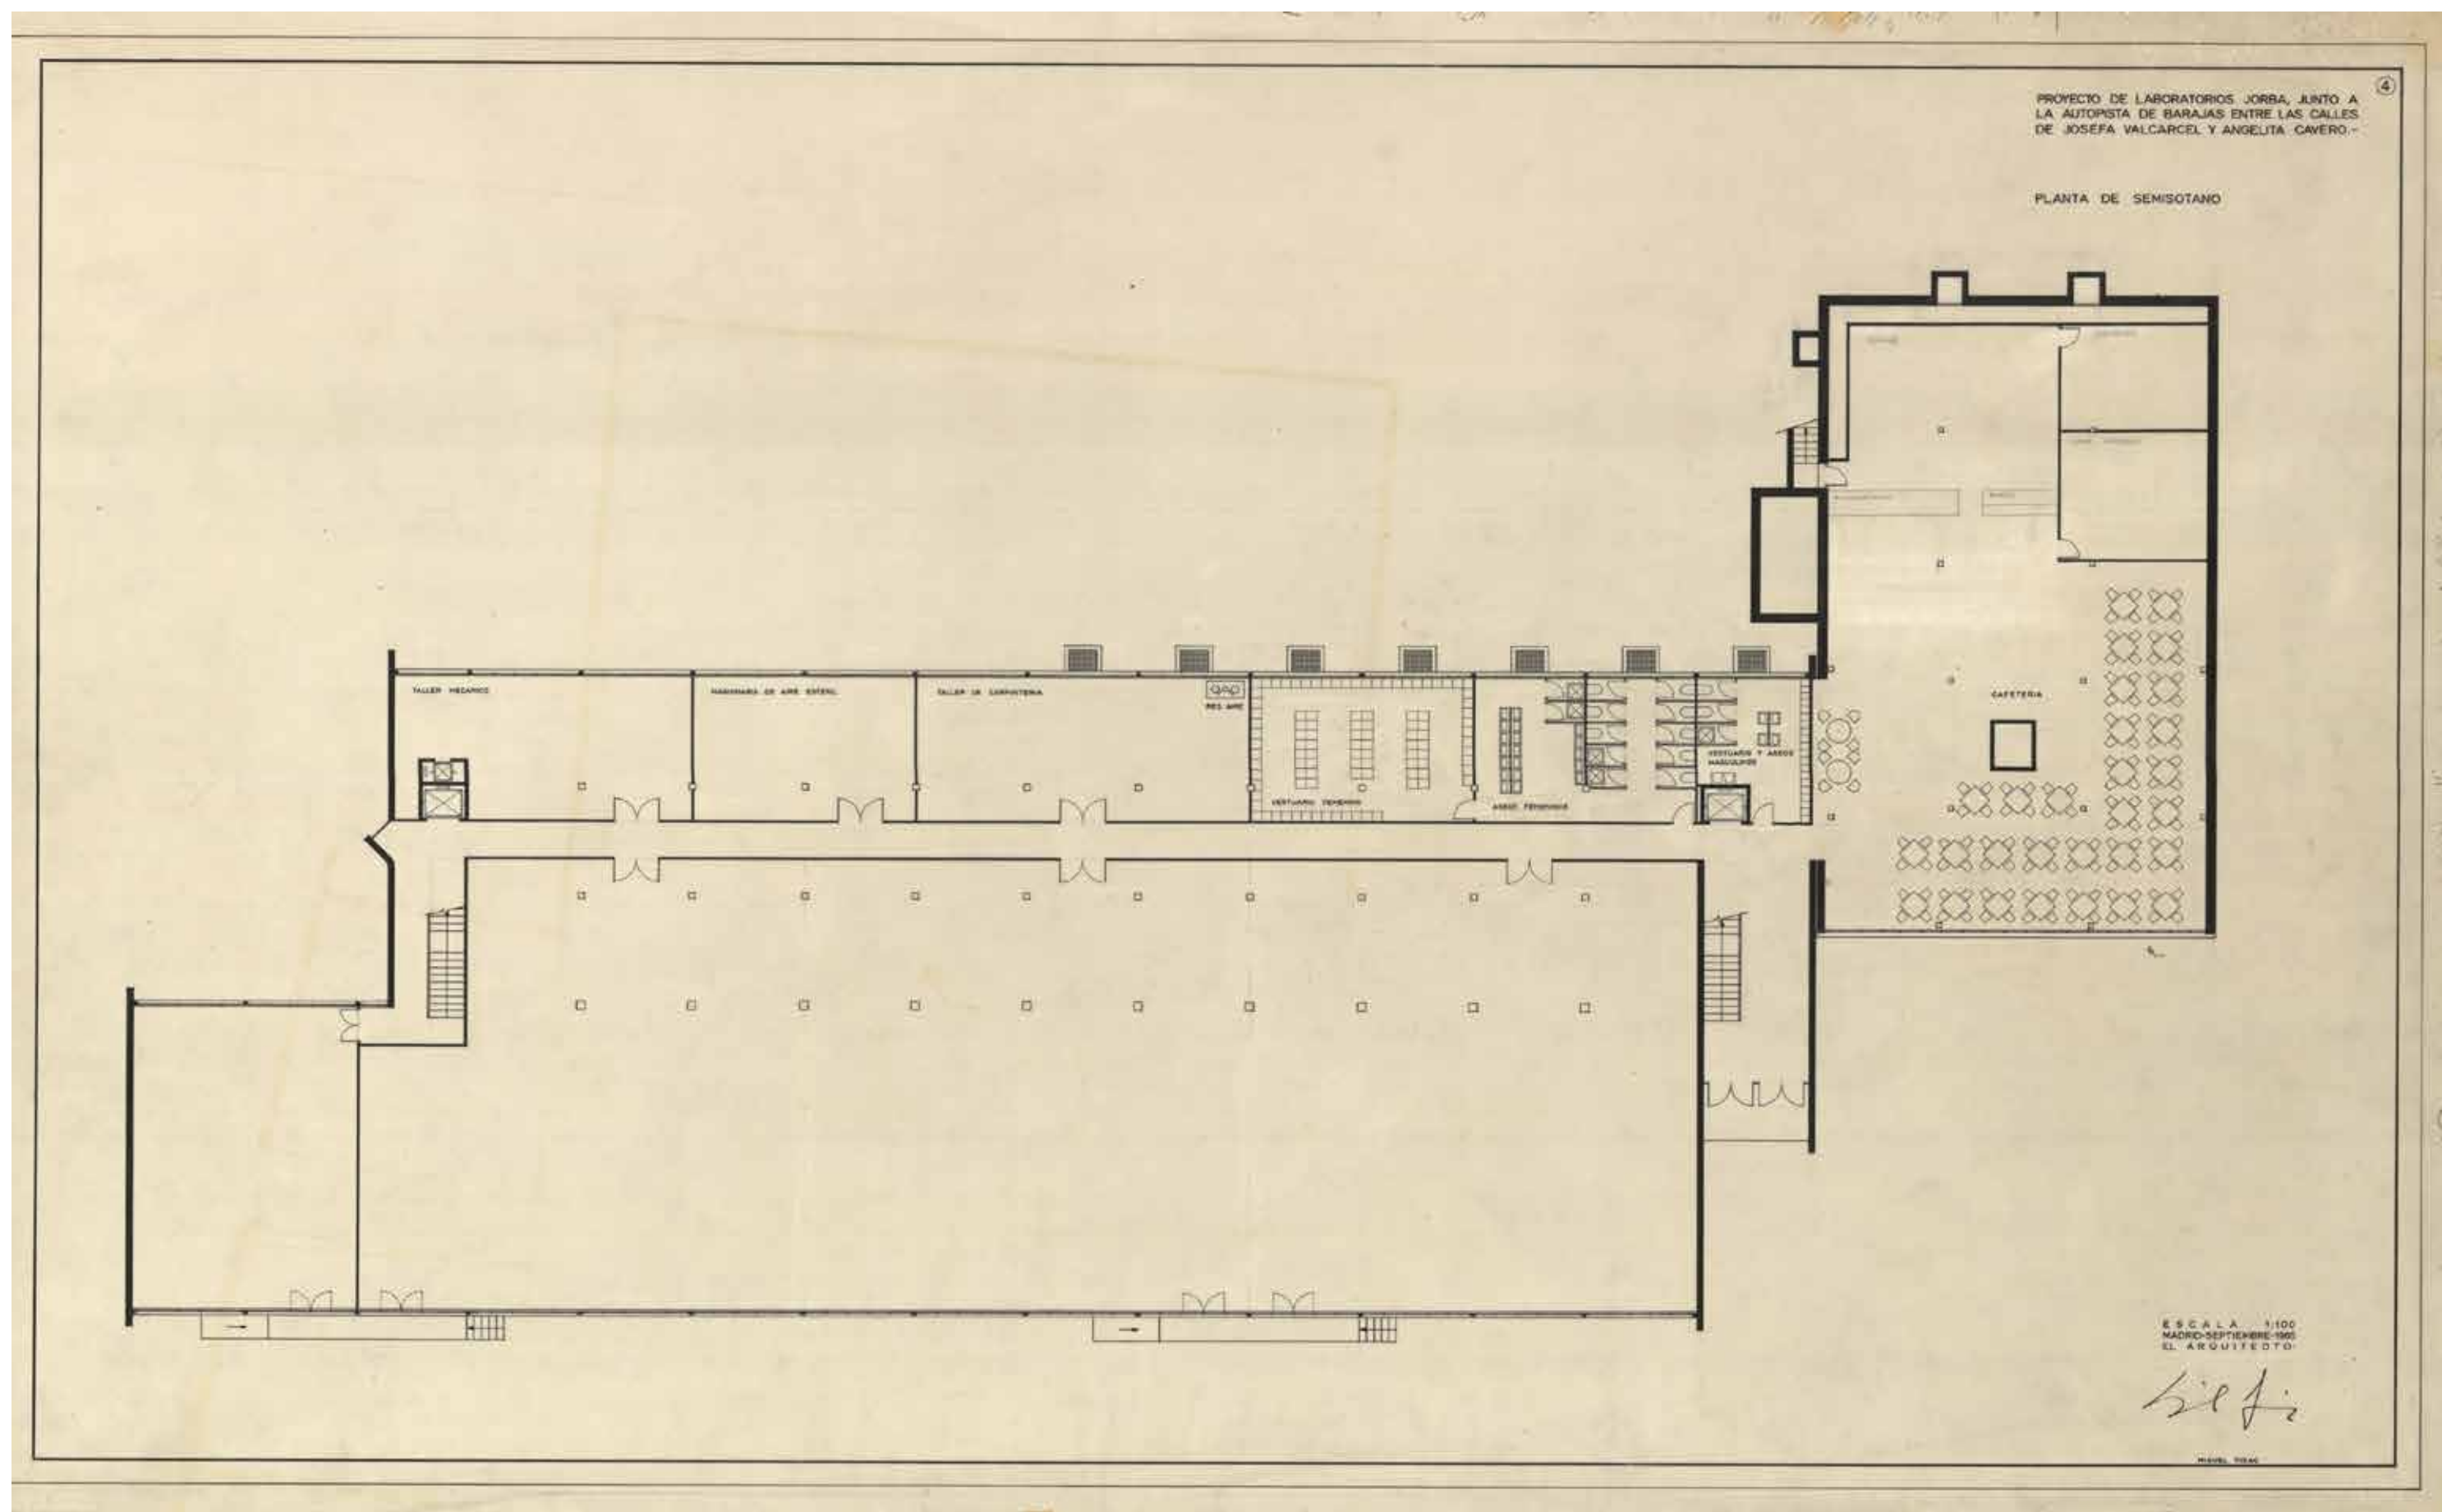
FIGURA: Planta sótano de los Laboratorios Jorba. Proyecto original de Miguel Fisac
